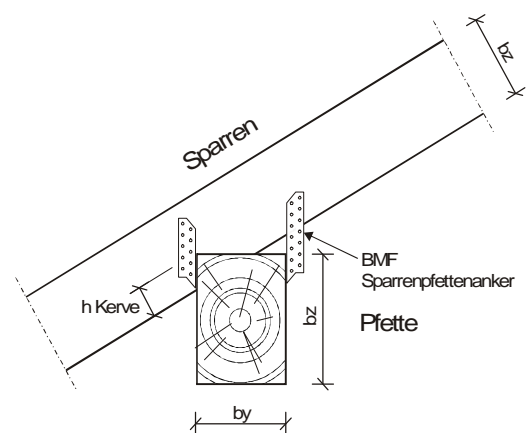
Verankerung eines Dachsparren mit BMF-Sparrenpfettenankern
